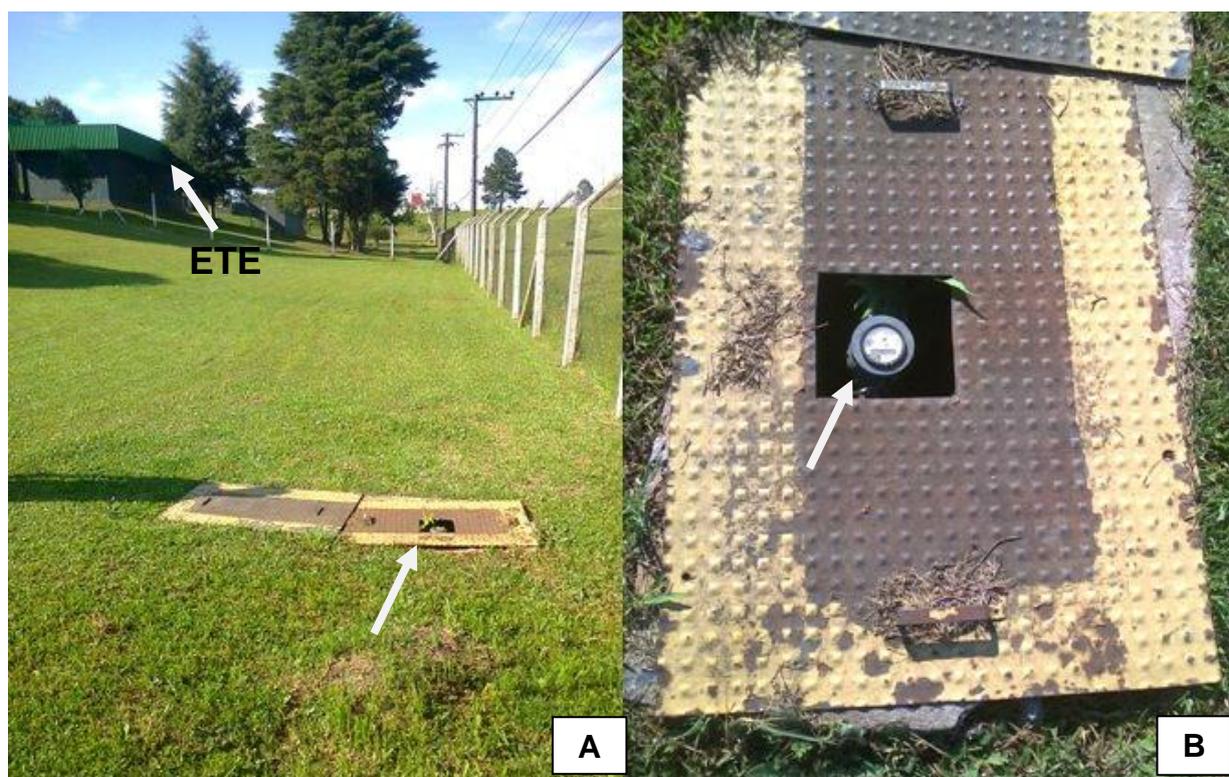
(A) Localização do hidrômetro BR 116; (B) Hidrômetro BR 116.
